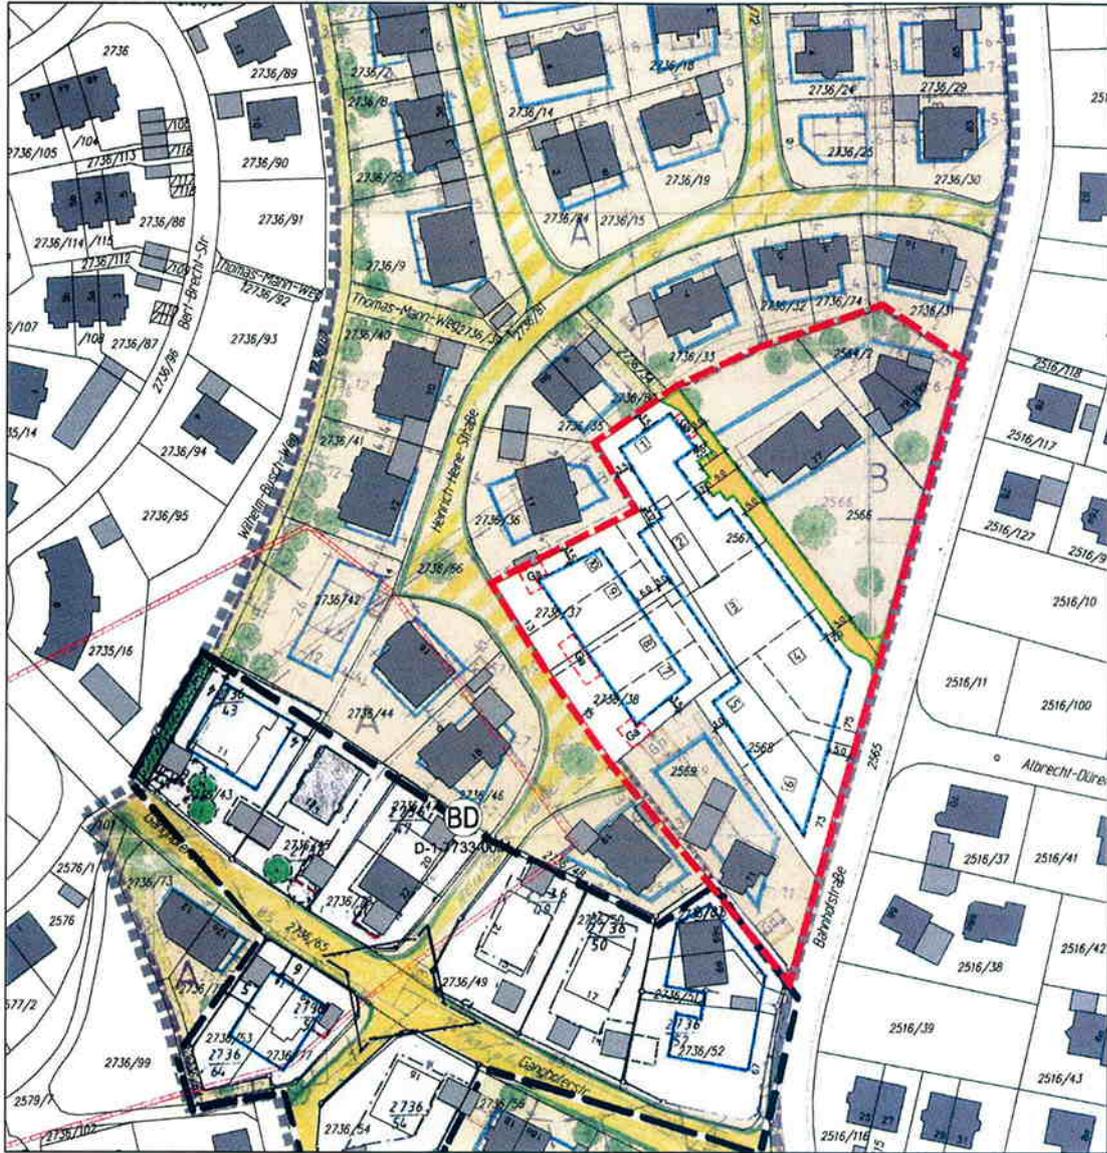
Bebauungsplan "Westlich der Bahnhofstraße" Synopsenplan mit zeichnerischen Änderungen
